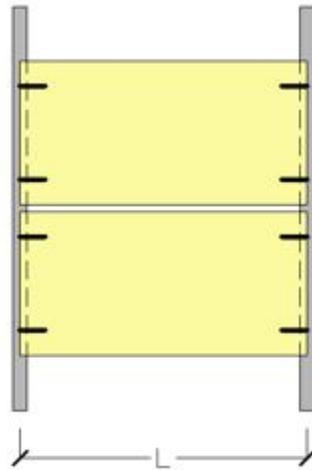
Esquema da instalação das pedras com fixação pelos topos verticais
